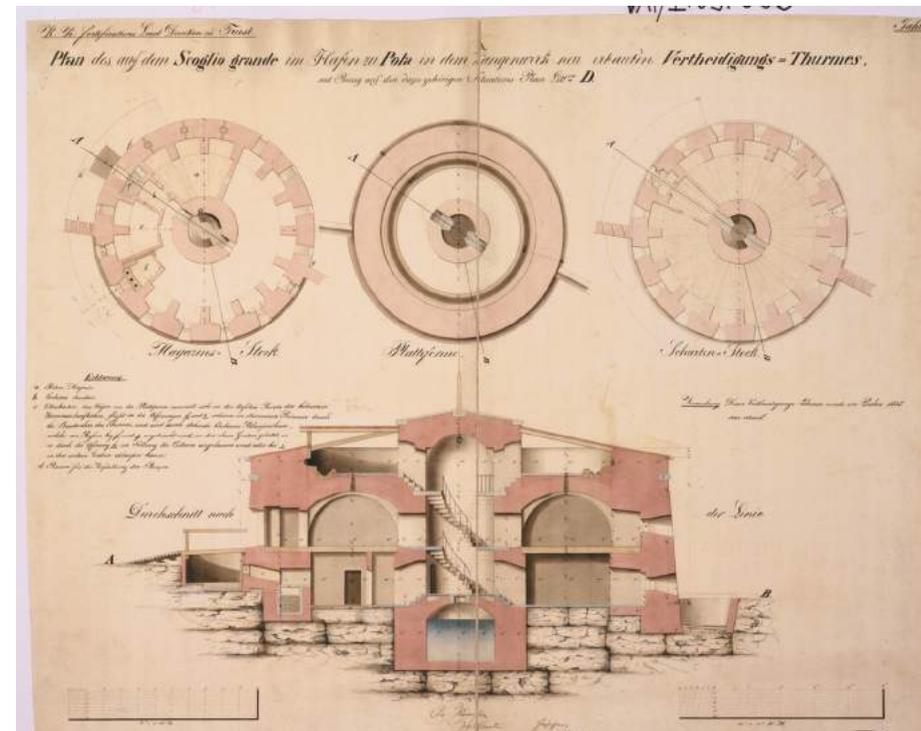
, Grundrisse und Schnitt von Fort Franz
